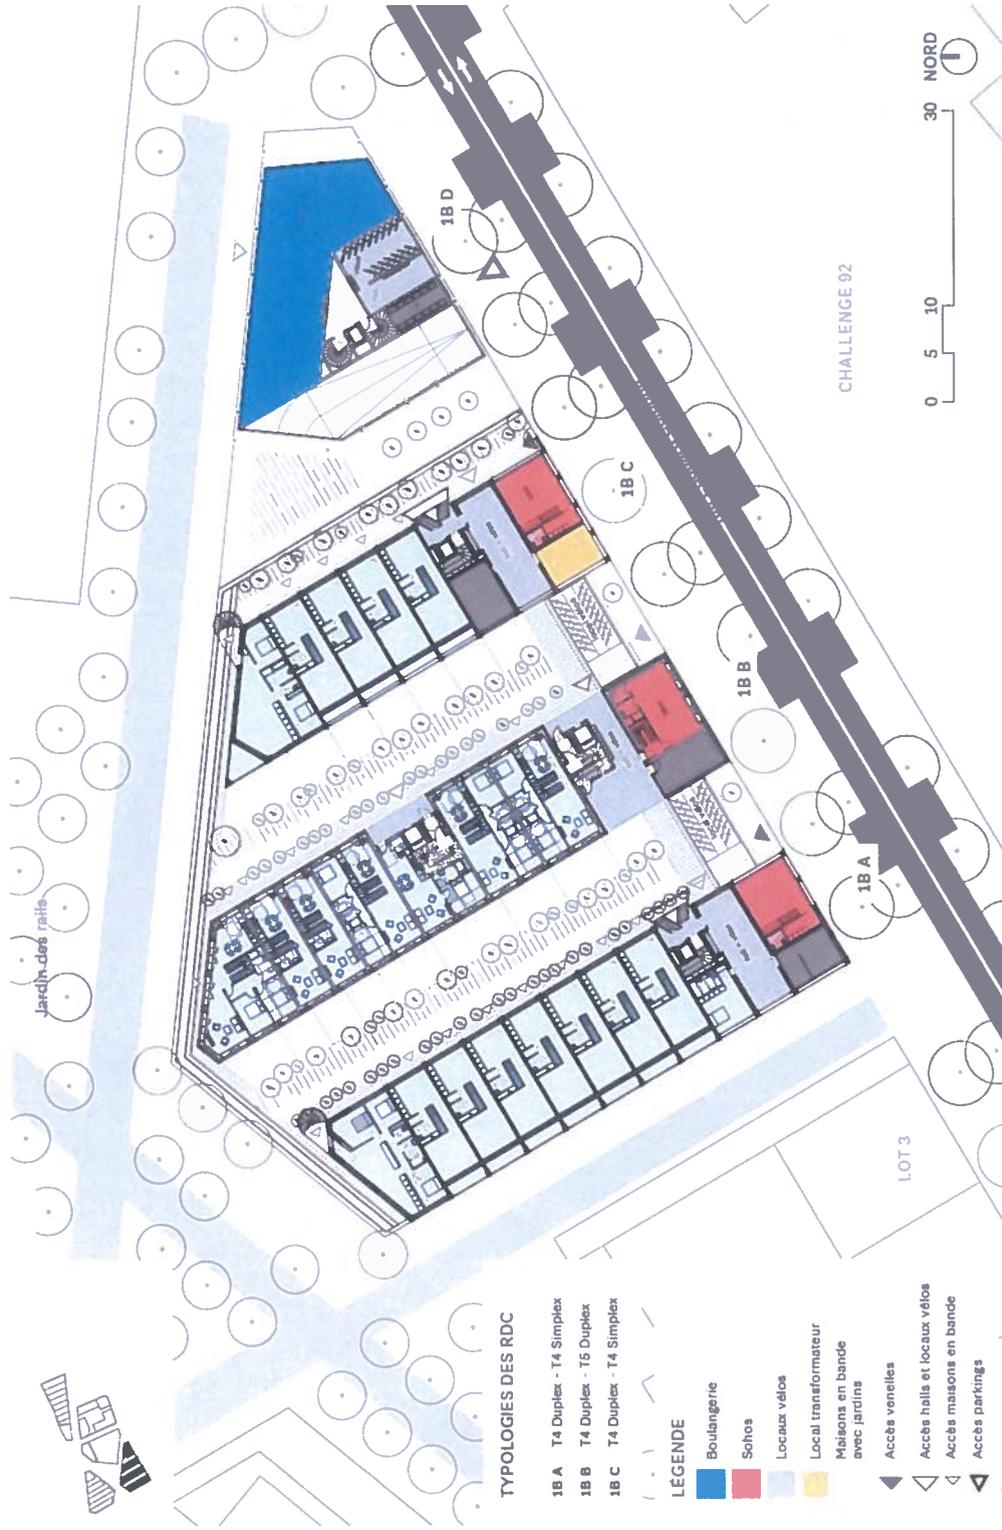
Plan du RDC ilot 1B – Martin Duplantier Architectes
